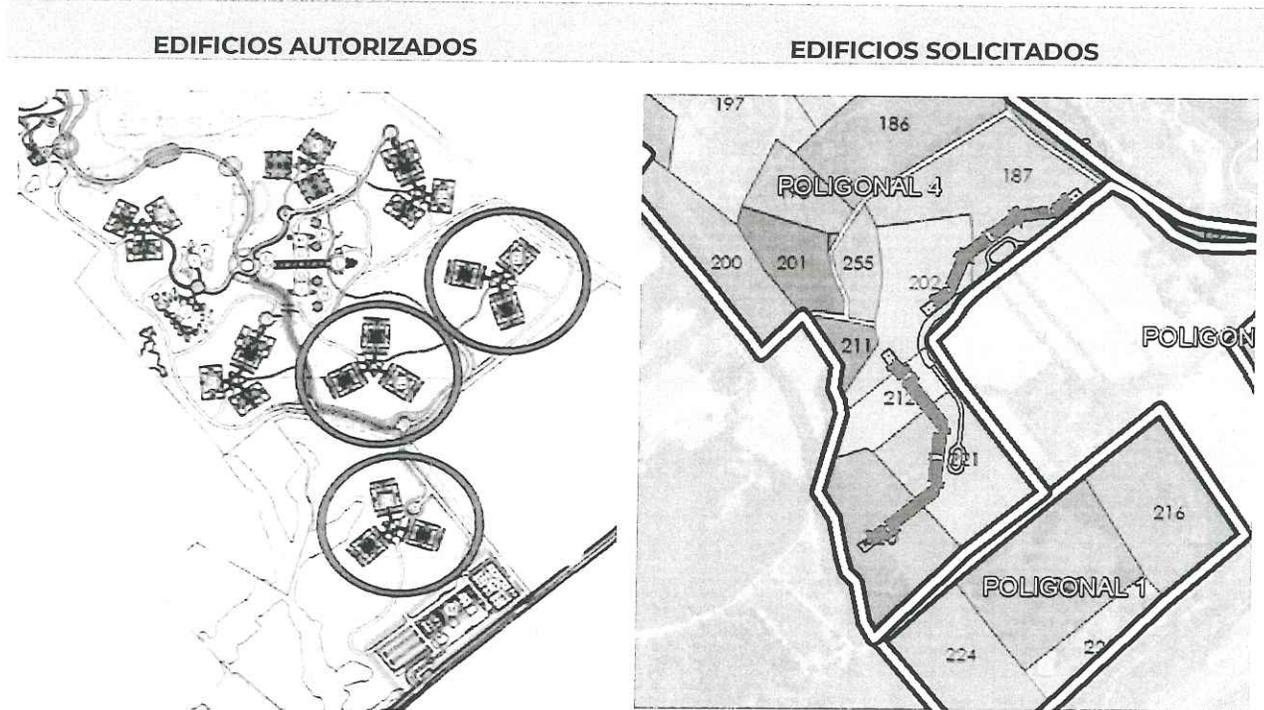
Planos de edificaciones autorizadas y solicitadas en esta modificación dentro de las unidades parcelarias del PROYECTO Villas Jungle.
